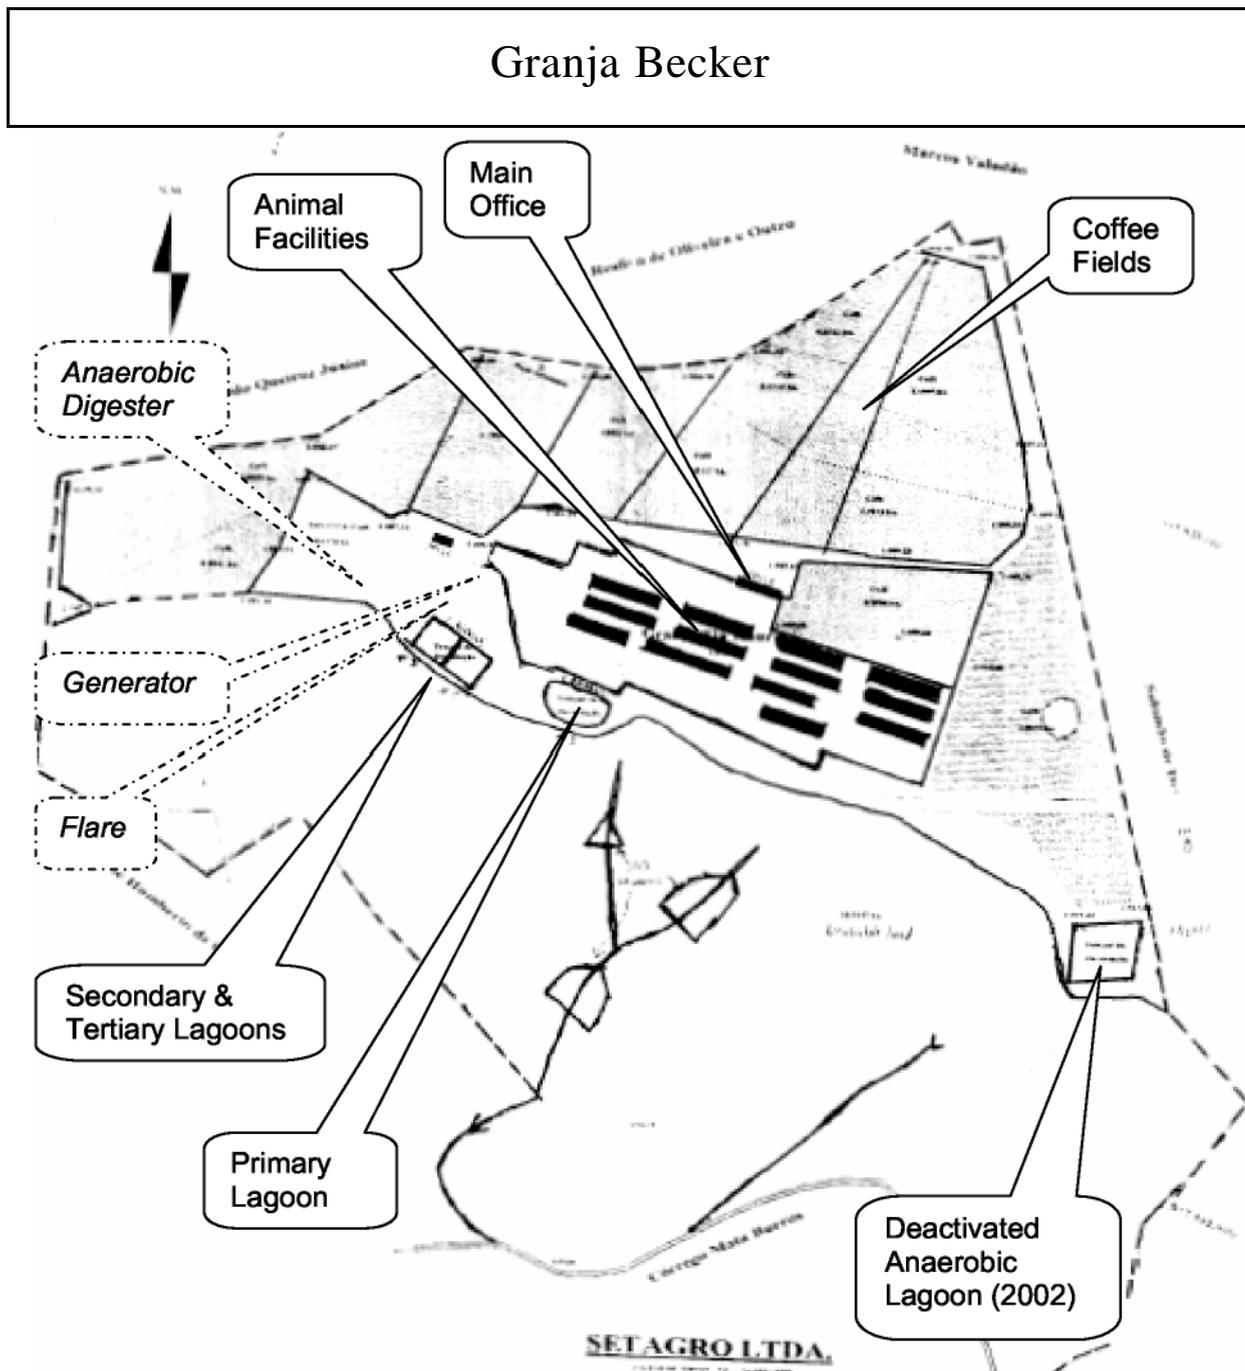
Layout da Granja Becker (Pré-construção), a locação pós- construção do digester, queimador e gerador estão marcadas.
